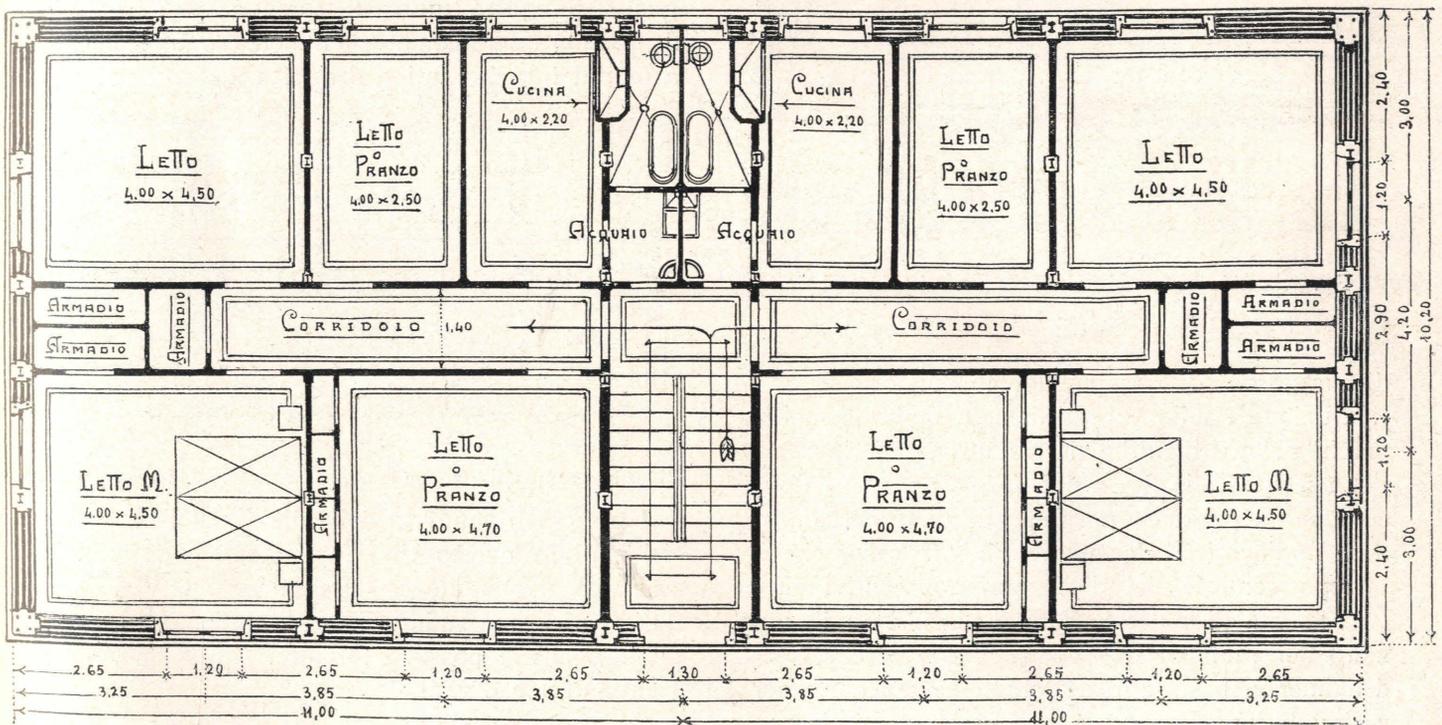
Pianta dell'edificio fondamentale; piano terreno simile al primo piano, con due alloggi per piano di 5 camere.
